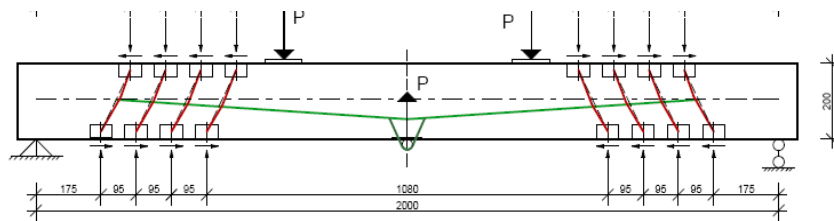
Регульовано напружена залізобетонна балка з паралельно розташованою похилою арматурою
